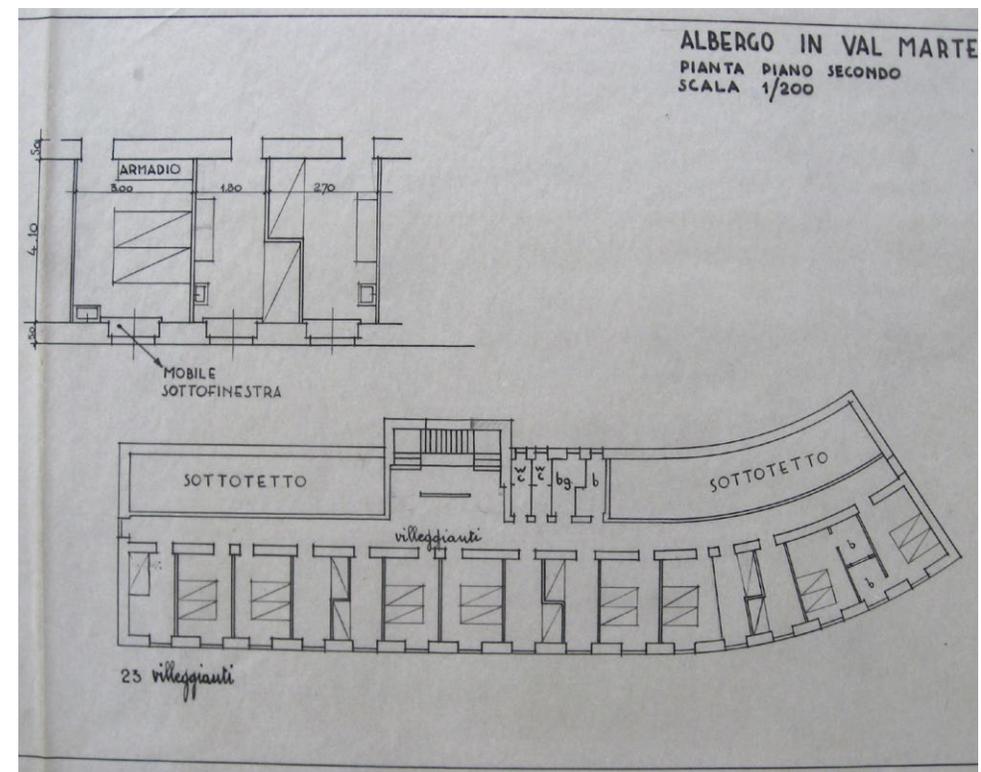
Grundriss Dachgeschoss mit hervorgehobenem Zimmer
